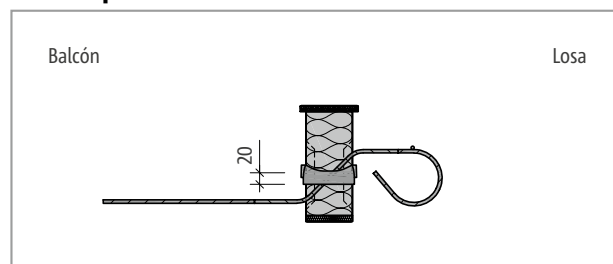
Schöck Isokorb® T tipo Q-V1 hasta Q-V5: Sección del producto
